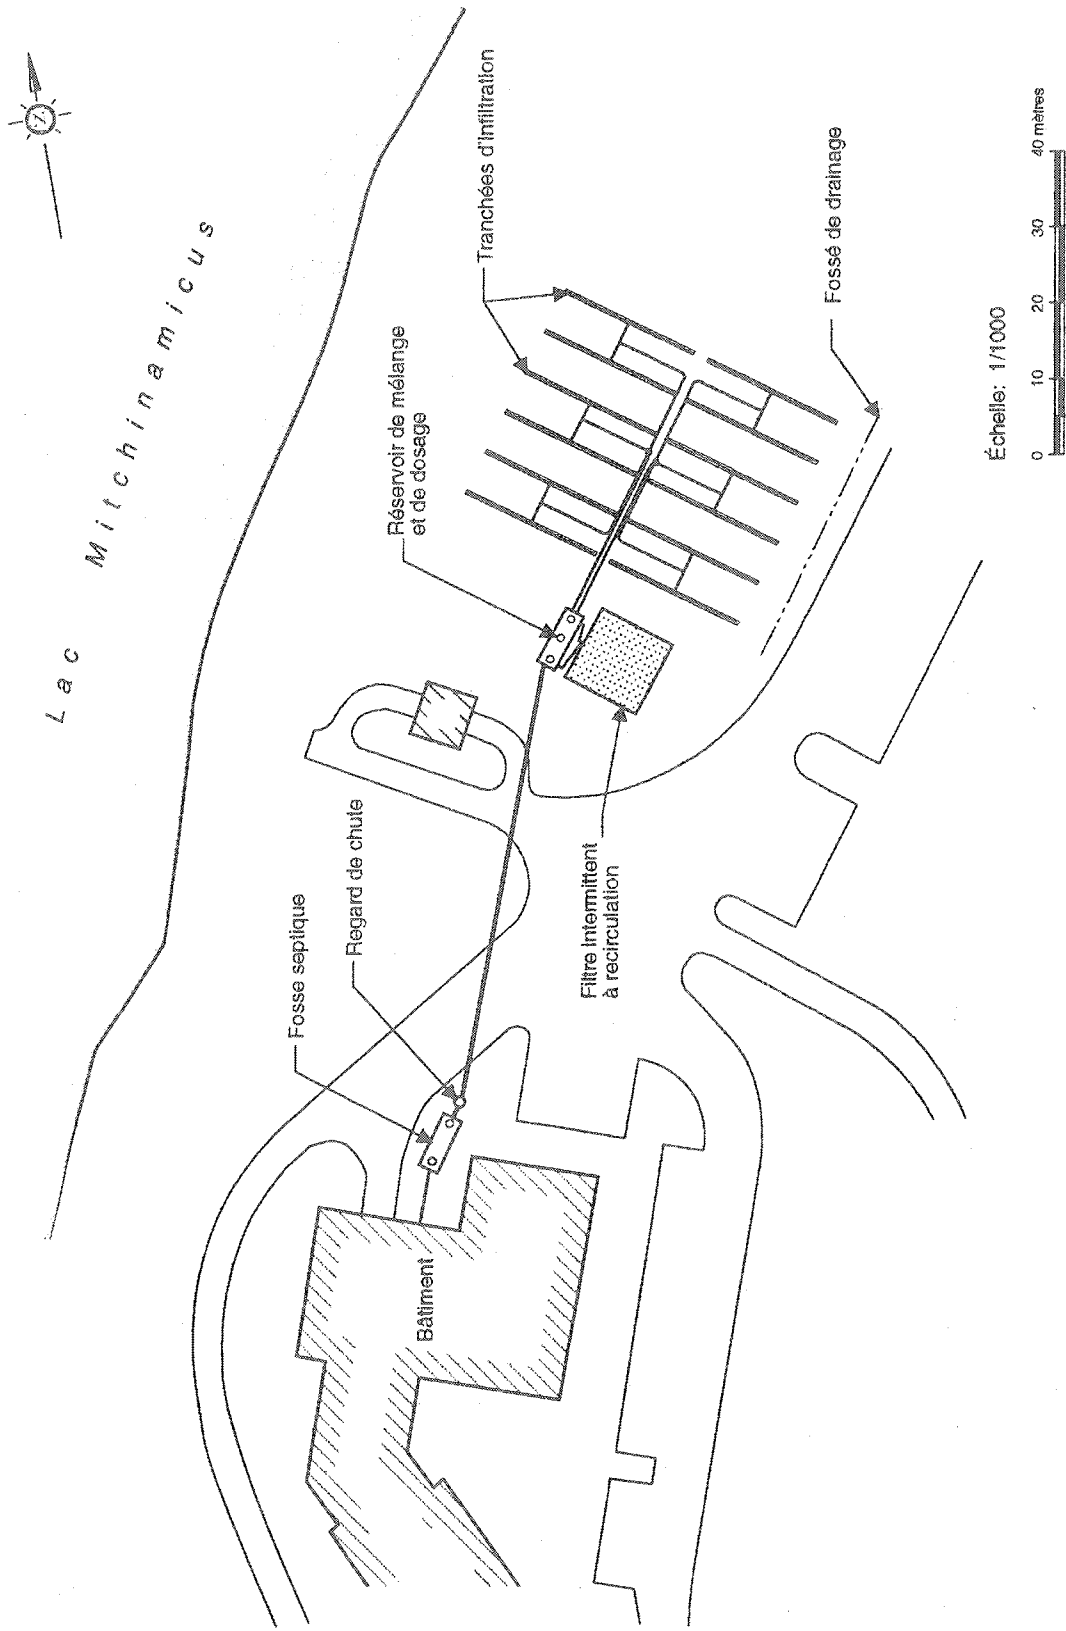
Le plan d'implantation du traitement au poste La Vérandrye
